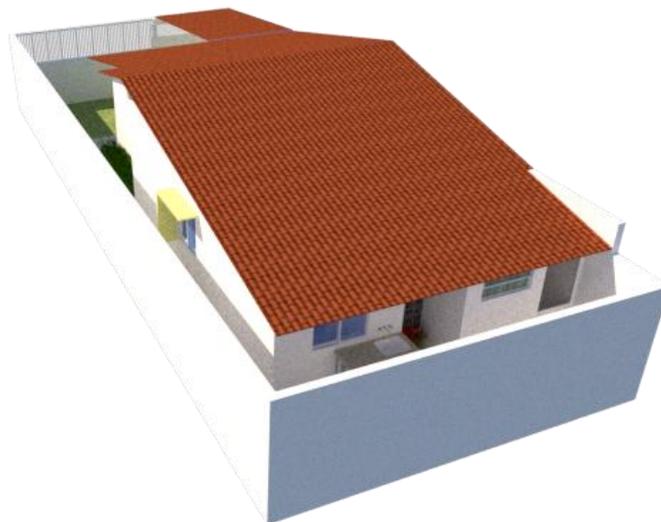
Proposta espelhada orientada à Noroeste - Fachada lateral
